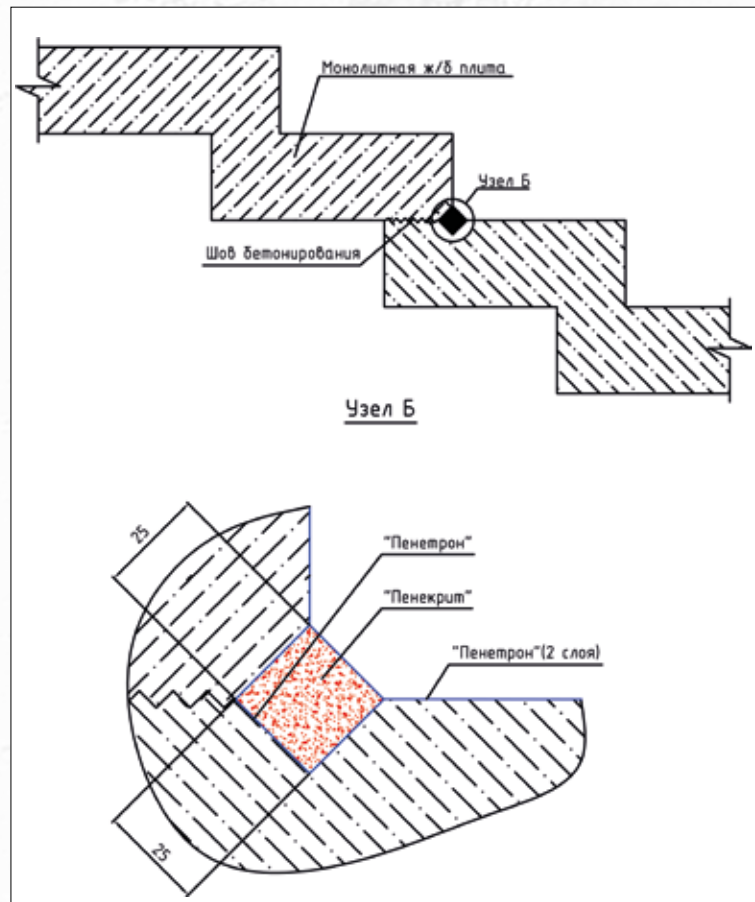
Схема устройства гидроизоляции швов бетонирования в уже существующих трибунных перекрытиях
